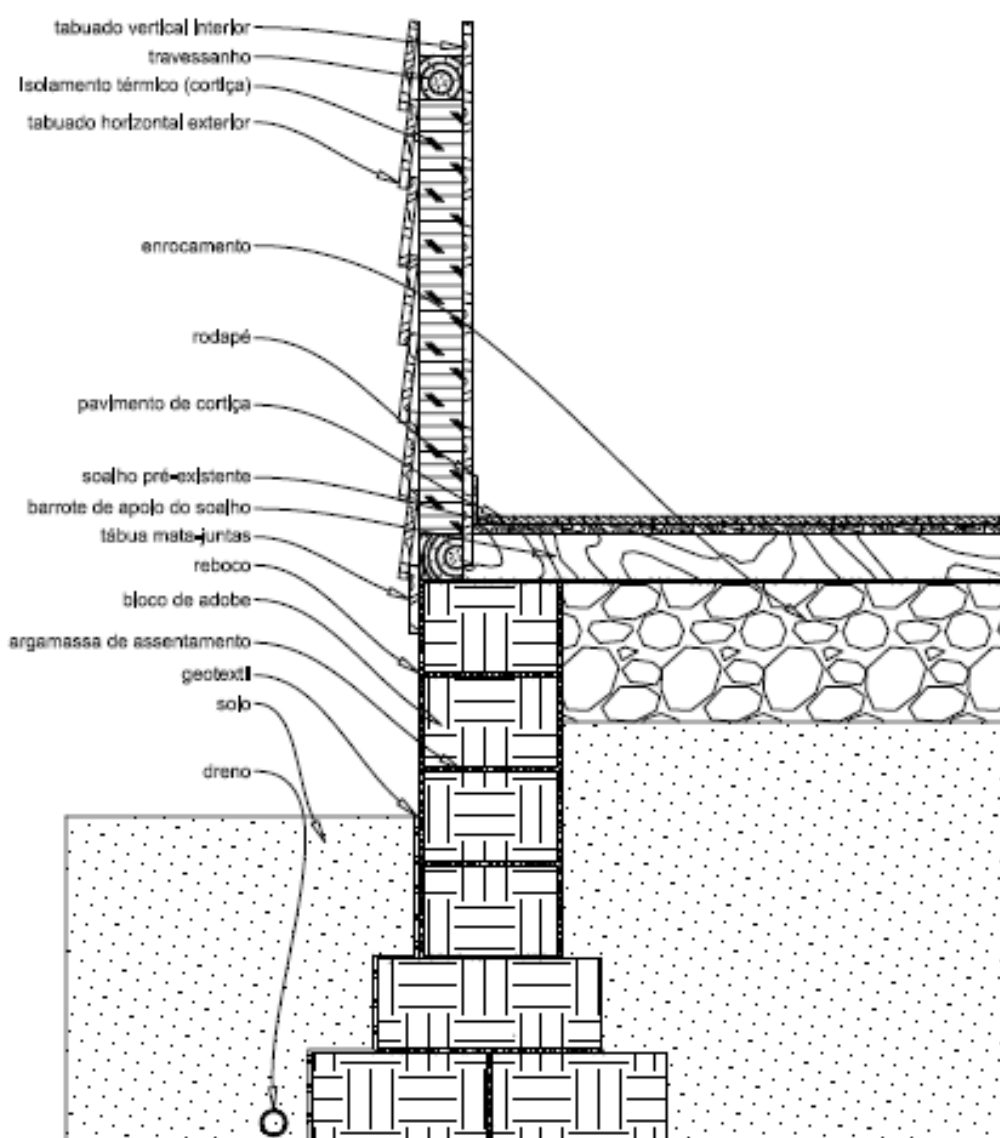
Proposta de aplicação de isolamento térmico e revestimento do pavimento
